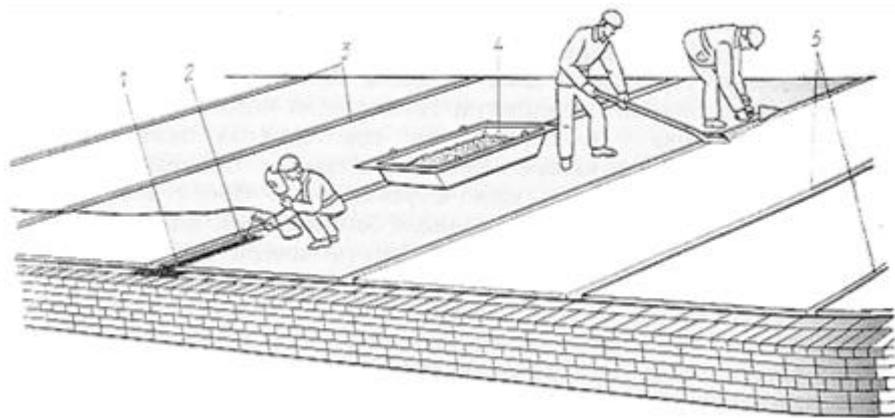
Установка анкеров и заделка стыков плит перекрытий:
